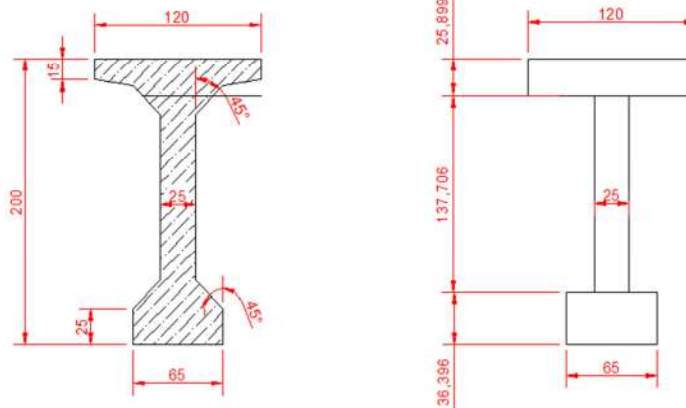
Dimensionnement d'une section équivalente à la section médiane
